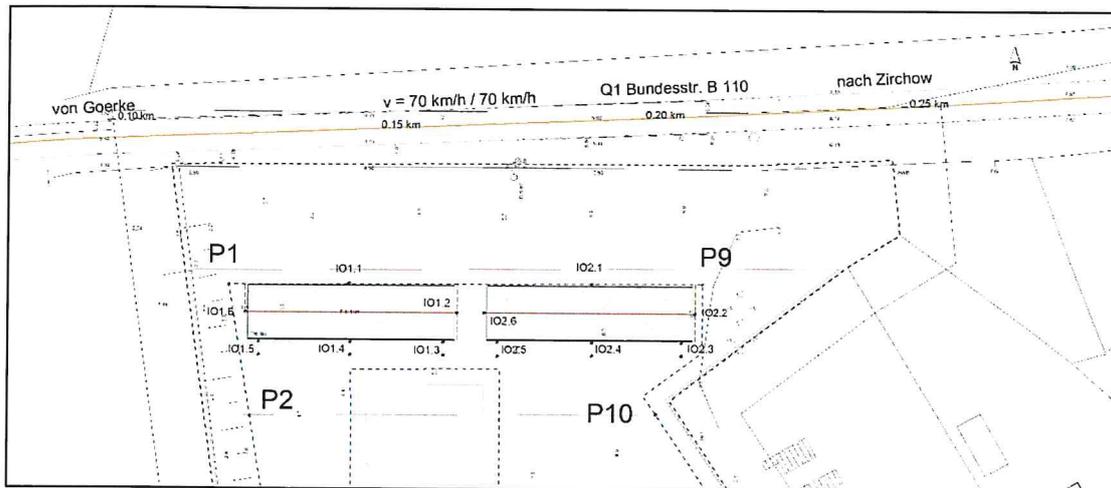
Riegelbebauung an der nördlichen Plangebietsgrenze
